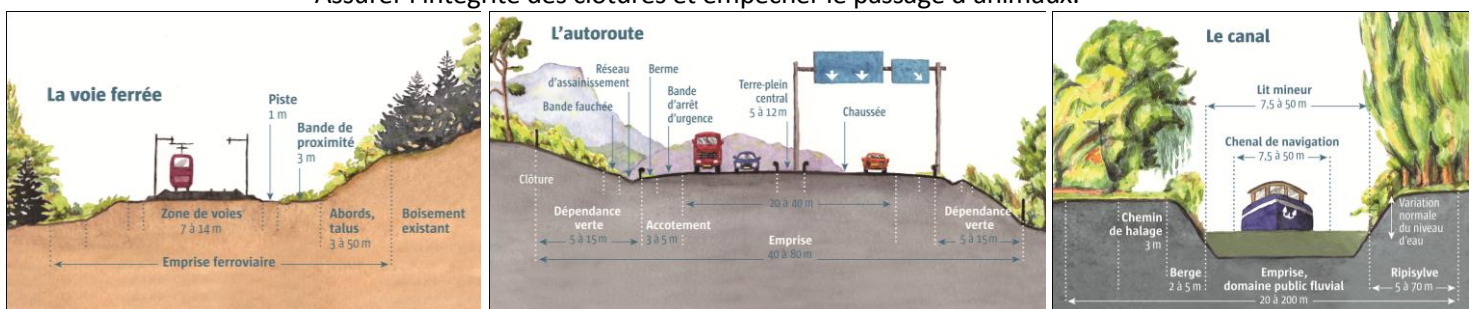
Schéma d'une coupe d'emprise ferroviaire
